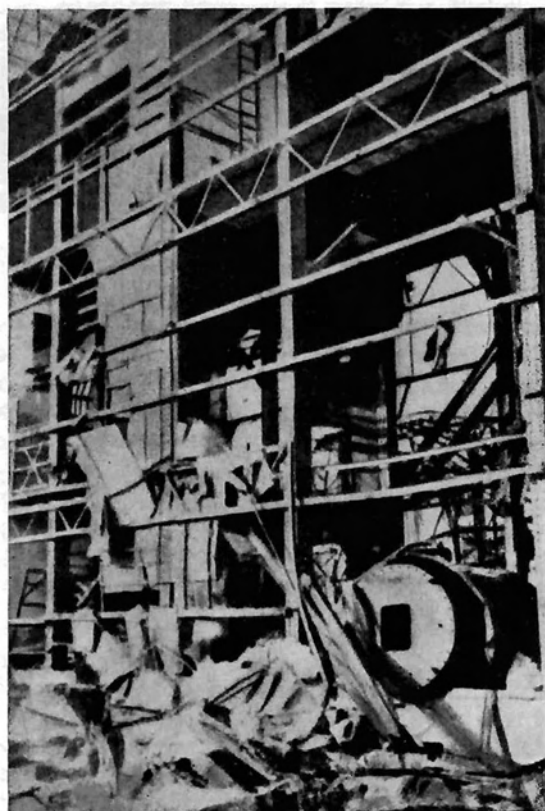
ist die Wiedergabe eines Stahlskelettbauwerks aus Hiroshima in 800 m Entfernung vom sogenannten Null-Punkt. Die Ausfachung ist wohl herausgeschlagen, jedoch wurde hierbei ein Druckausgleich geschaffen und der Bau
